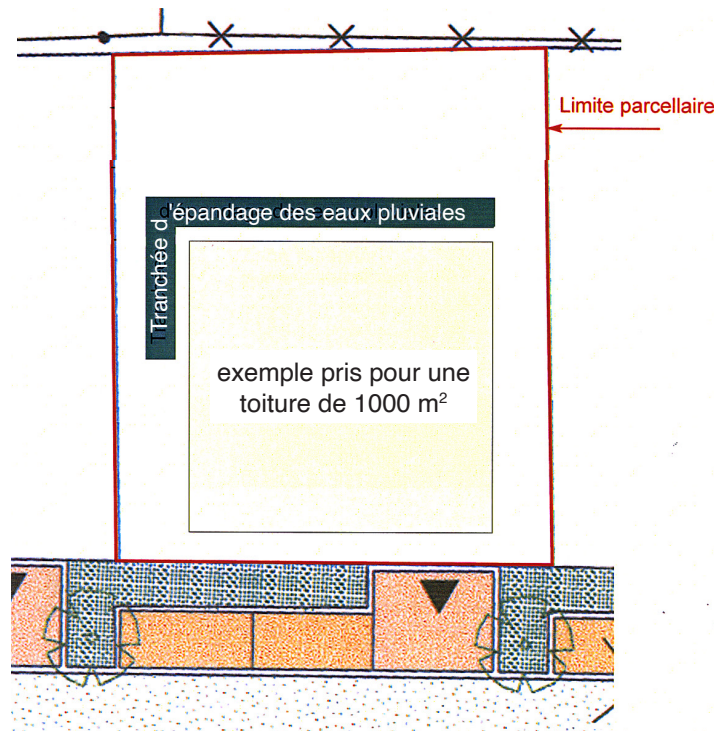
Exemple de disposition d'une tranchée d'infiltration pour l'assainissement pluvial d'une construction dans une parcelle privée
